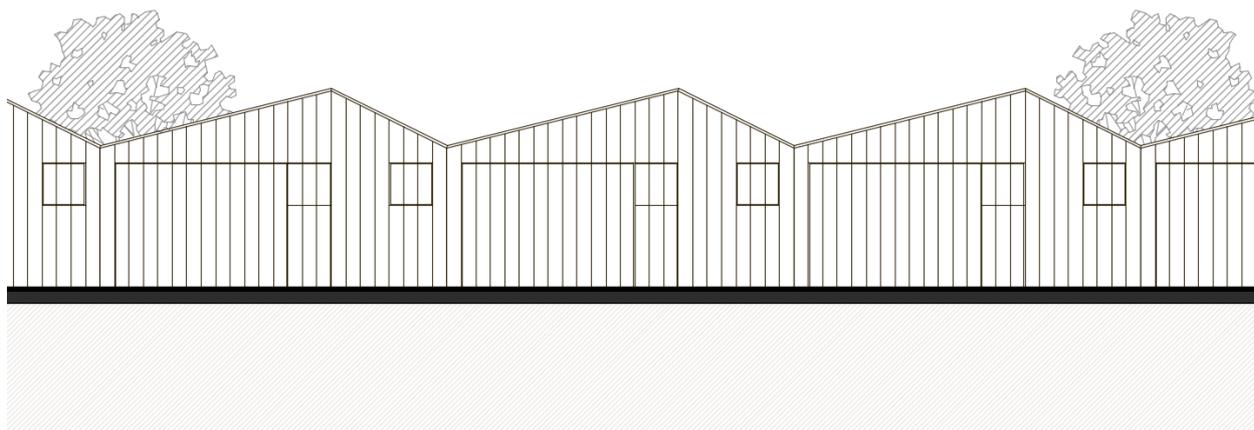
instalações dos Aprestos dos Pescadores – Alçado poente parcial – Plano Geral
